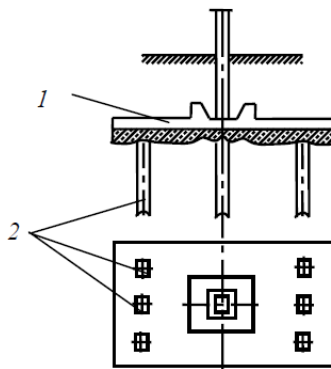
Свайный фундамент: 1 – железобетонный башмак; 2 – сваи
